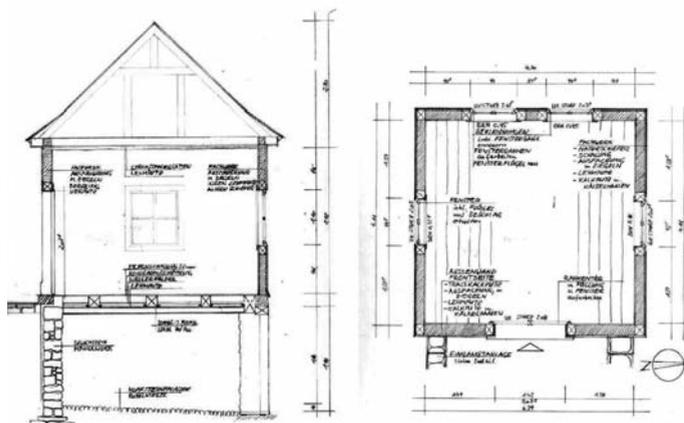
Schnitt und Grundriss Gartenhaus der „Armen Schulschwestern“
